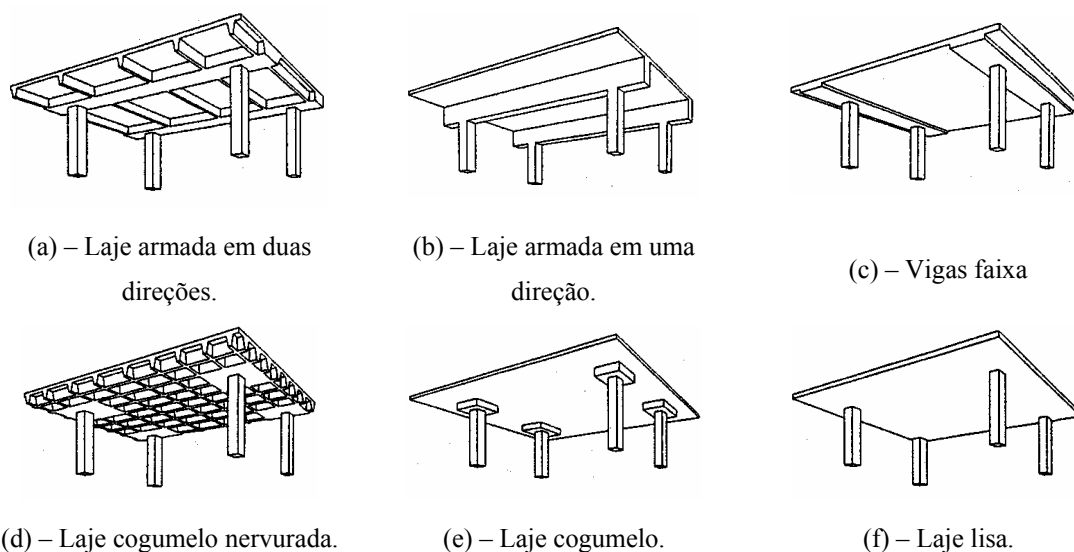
Tipos de sistemas de pavimentos – Aalami e Bommer (1999)
